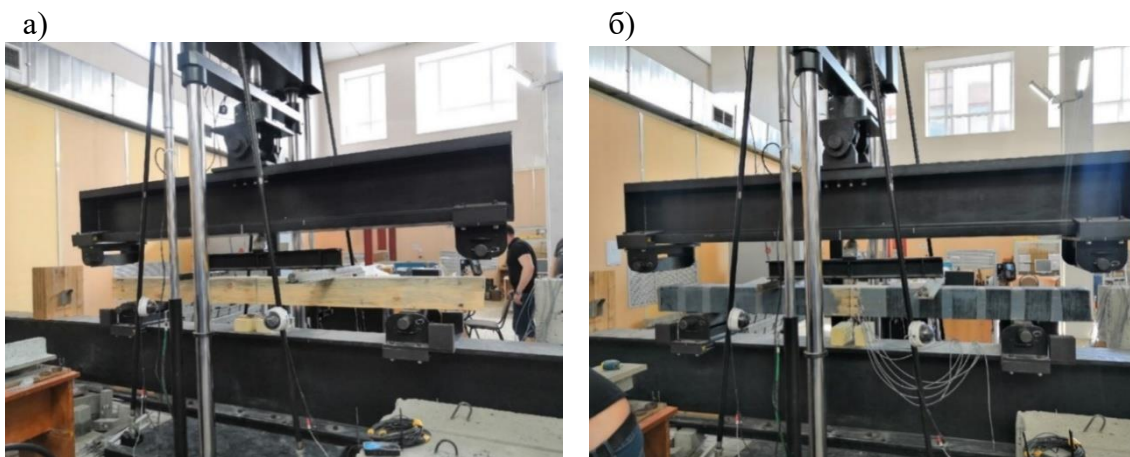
Внешний вид оборудования при испытании цельной мостовой деревянной балки: а) не армированной; б) армированной УВ лентой
